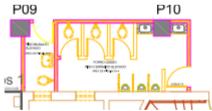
Planta de demolição - localização no Banheiro existente (1ºpavimento)
